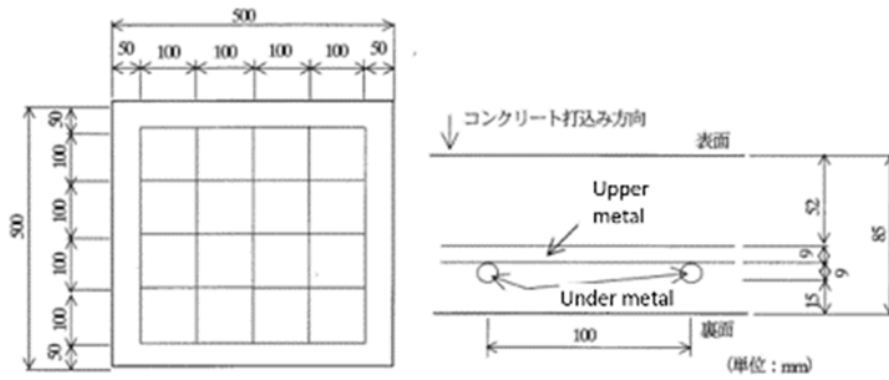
Geometrie der Probekörper mit Position der Bewehrungsstäbe.
